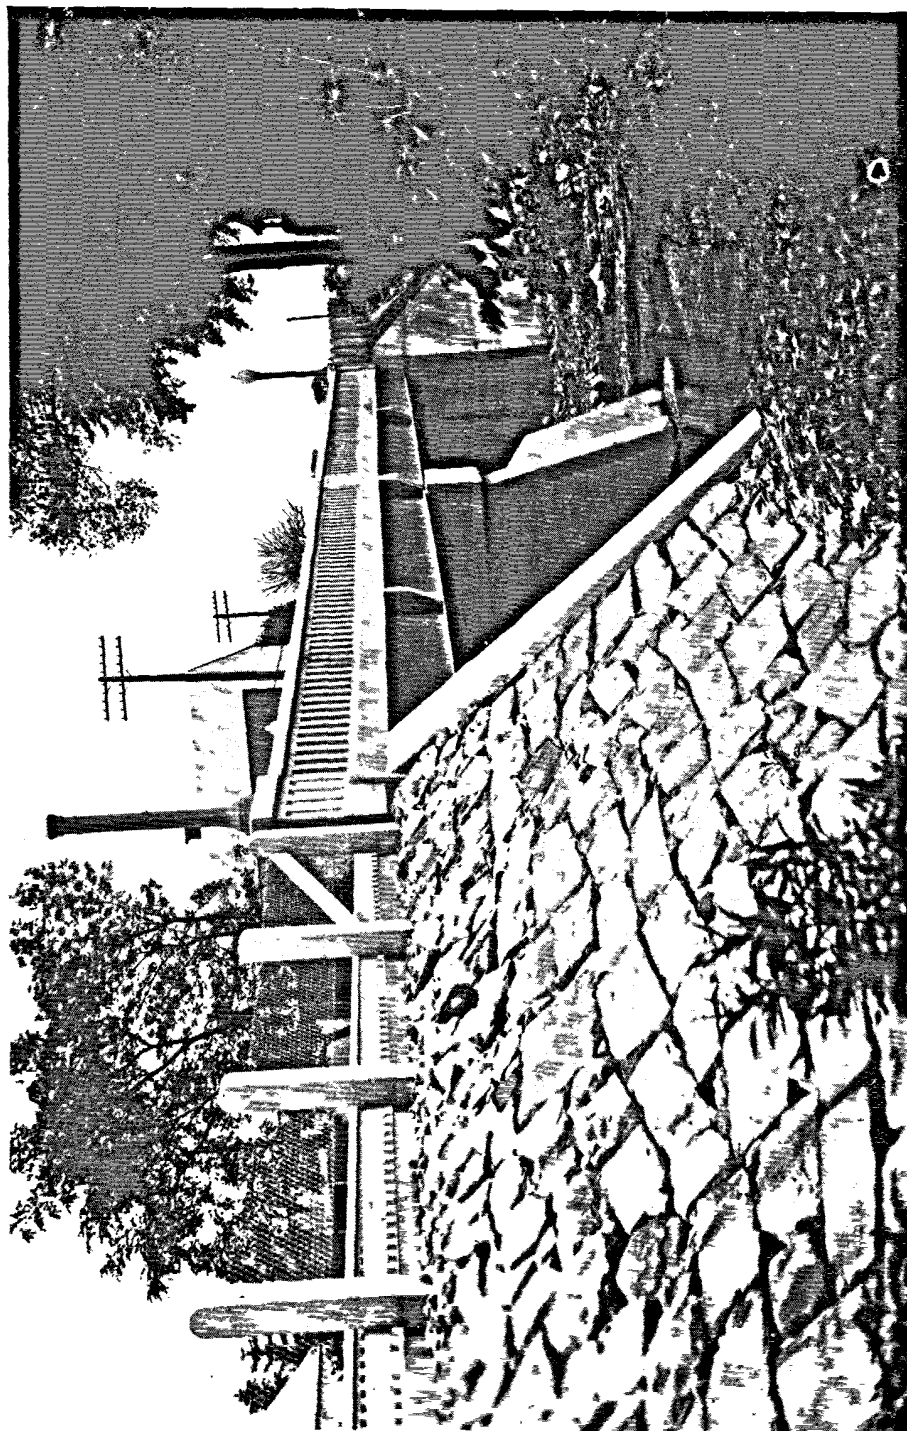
PONT SUR LA RIVIERE DES ANGLAIS A HOWICK, COMTÉ CHATEAUGUAY. SITE: PONT DU VILLAGE. (ROUTE MONTEAL-MALONE).—
